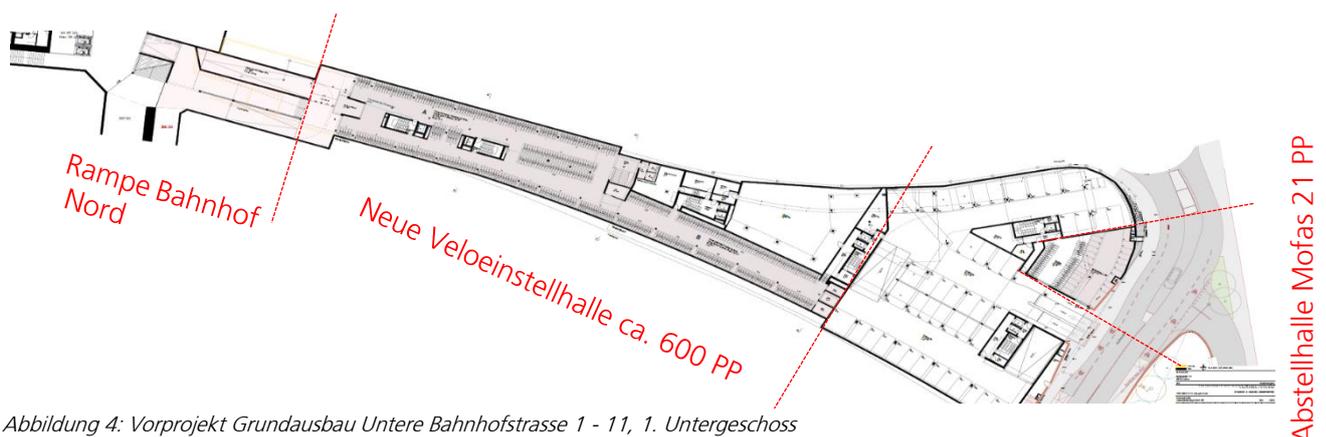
Vorprojekt Grundausbau Untere Bahnhofstrasse 1 - 11, 1. Untergeschoss
